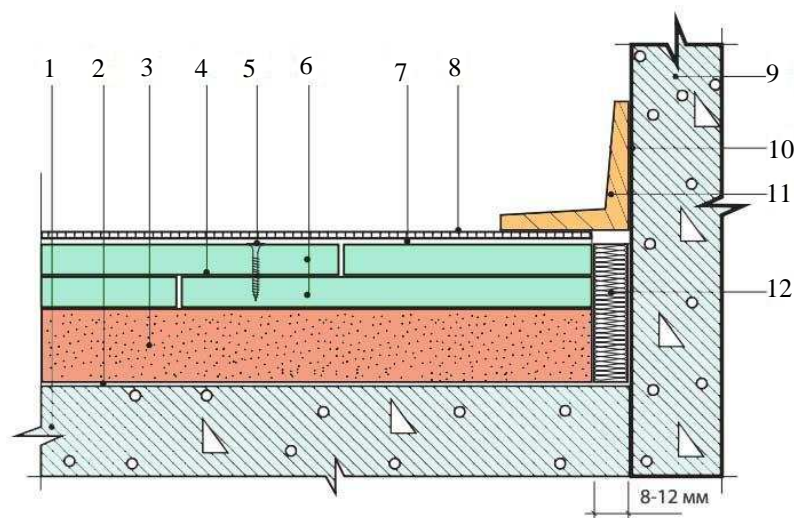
Улаштування збірної основи під підлоги: 1 – бетонне перекриття; 2 – гідроізоляція (поліетиленова плівка); 3 – вирівнювальна засипка з теплоізоляційного матеріалу (керамзит); 4 – клей ПВА; 5 – самонарізний гвинт для ГВЛ; 6 – елементи збірної основи підлоги з ГВЛ; 7 – клей для декоративного покриття підлоги; 8 – декоративне покриття підлоги (паркет, ламінат, лінолеум, кахельна плитка); 9 – бетонна стіна; 10 – кріплення для плінтуса; 11 – плінтус; 12 – крайкова стрічка
